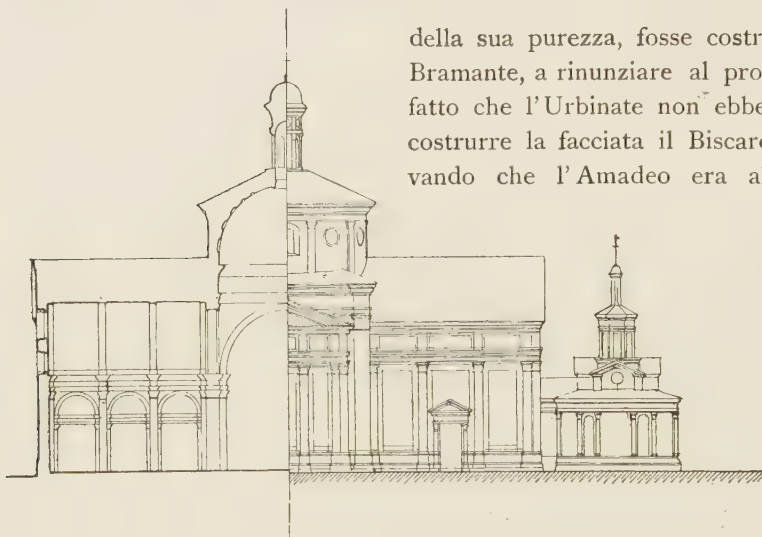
Sezione del transetto e fronte della chiesa verso via Falcone.
